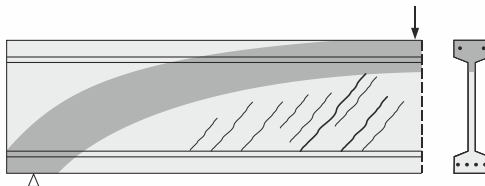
Ausbildung eines Druckbogens bei einem querkraftbeanspruchten Stahlbetonbauteil nach [Leo-1974]
